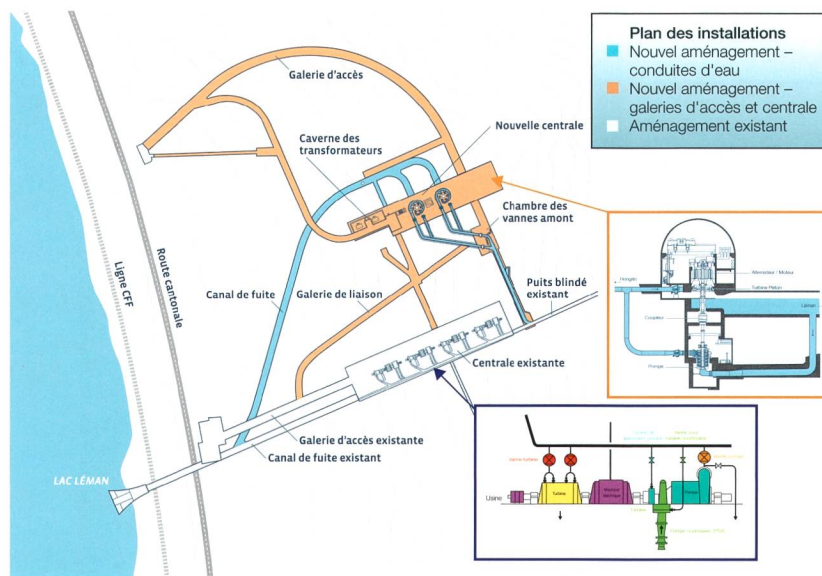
Plan et coupes des installations souterraines nouvelles et existantes.
